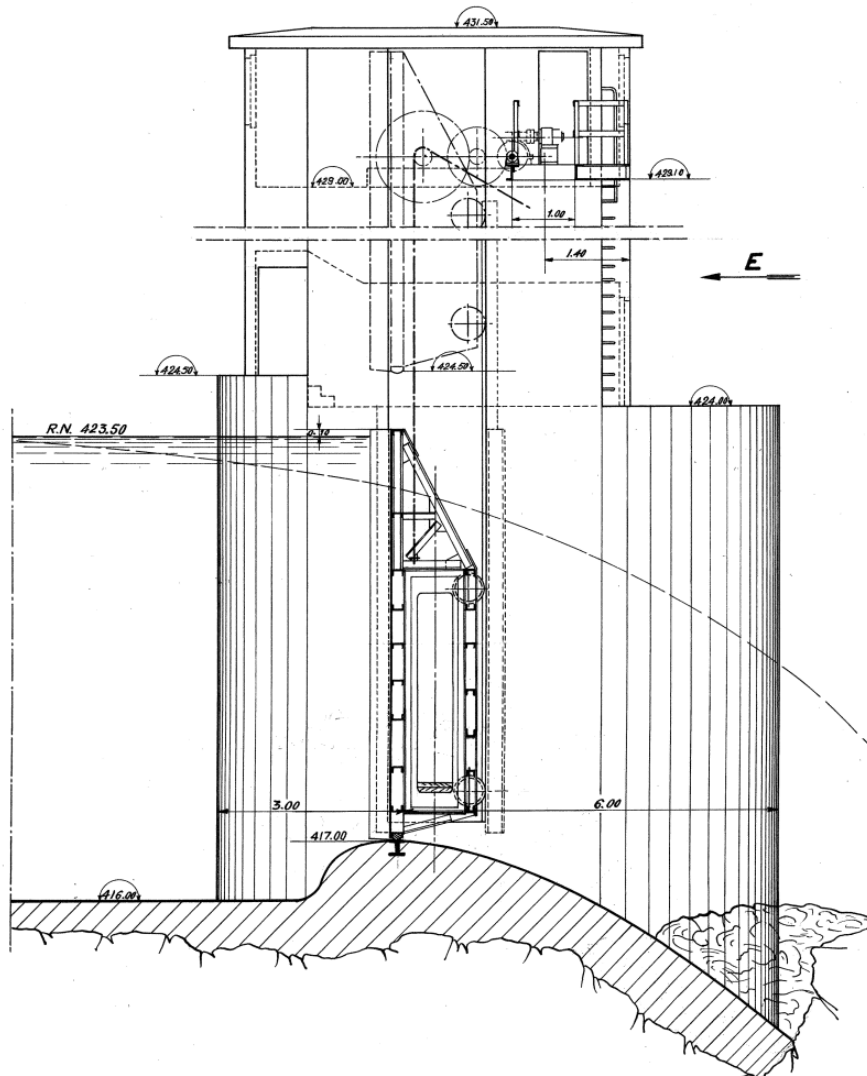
Vista en sección de las compuertas deslizates [10]
